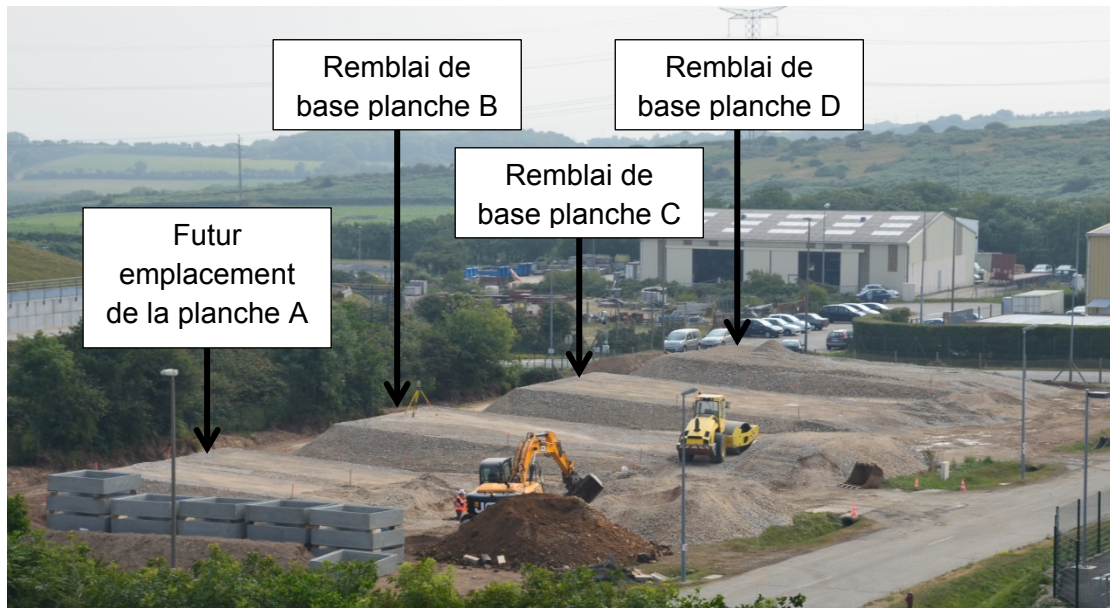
Photographie de la mise en œuvre du remblai de base des planches d'essais en grave 0/80 mm
